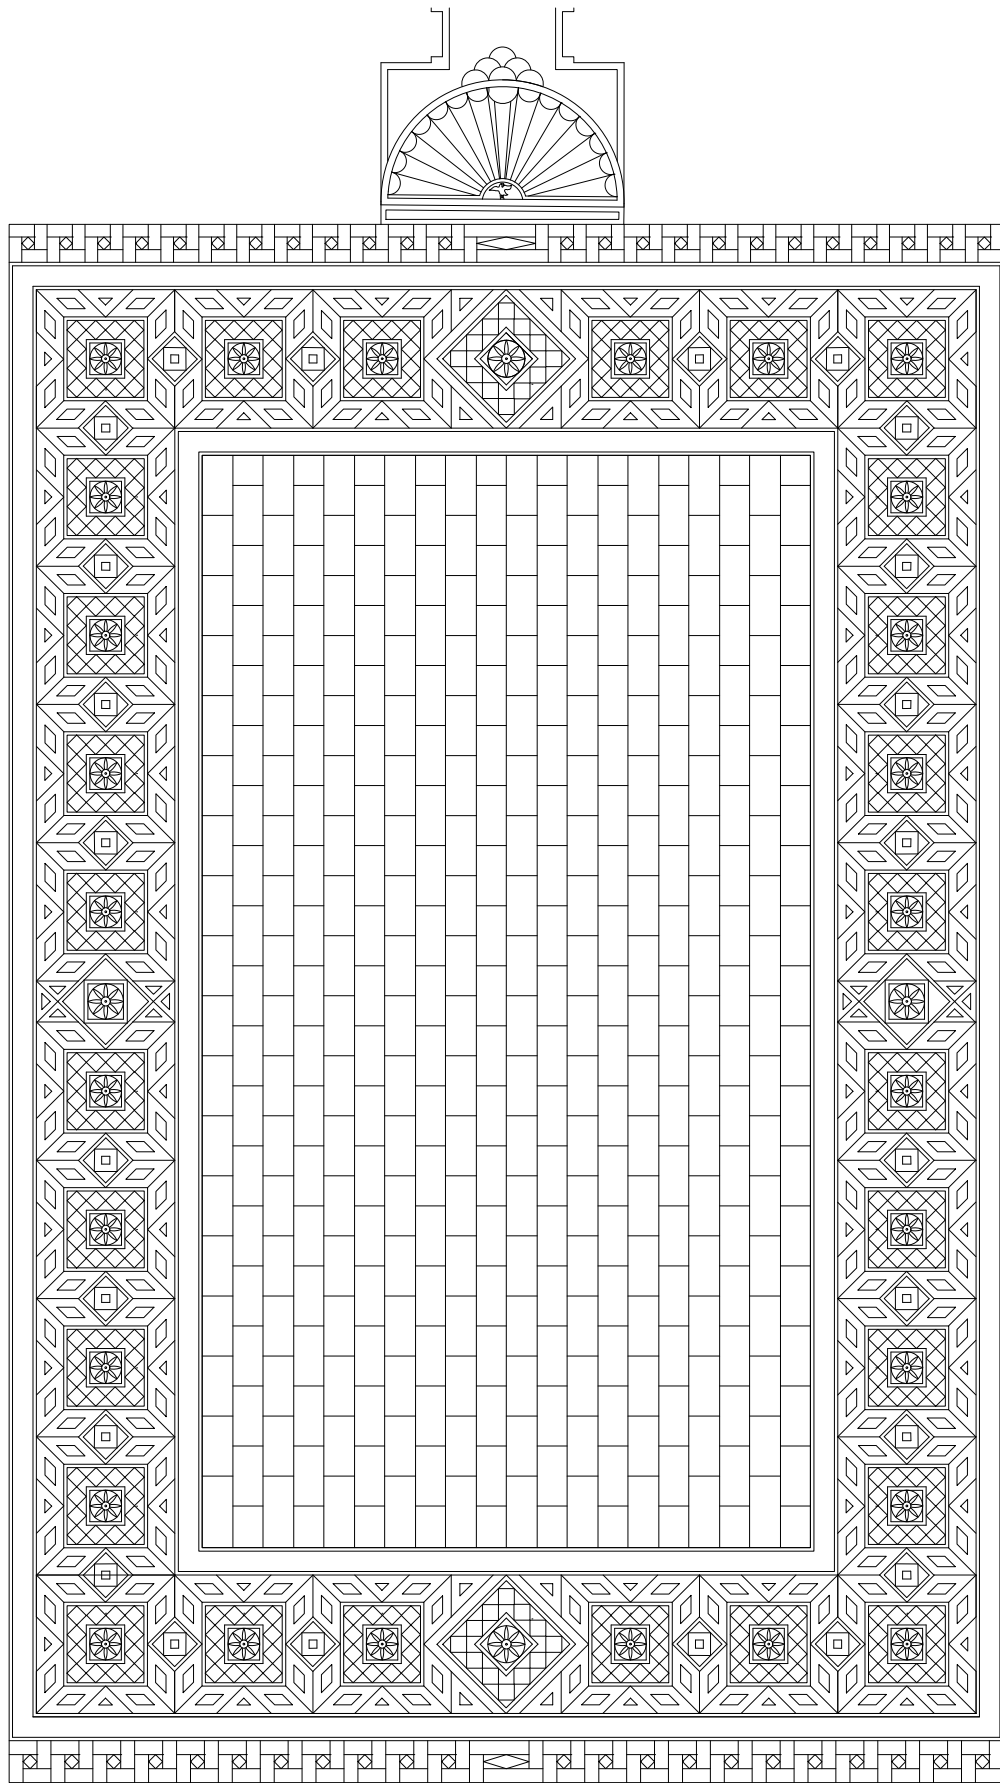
propuesta de reconstrucción del pavimento de la basilica termal.
